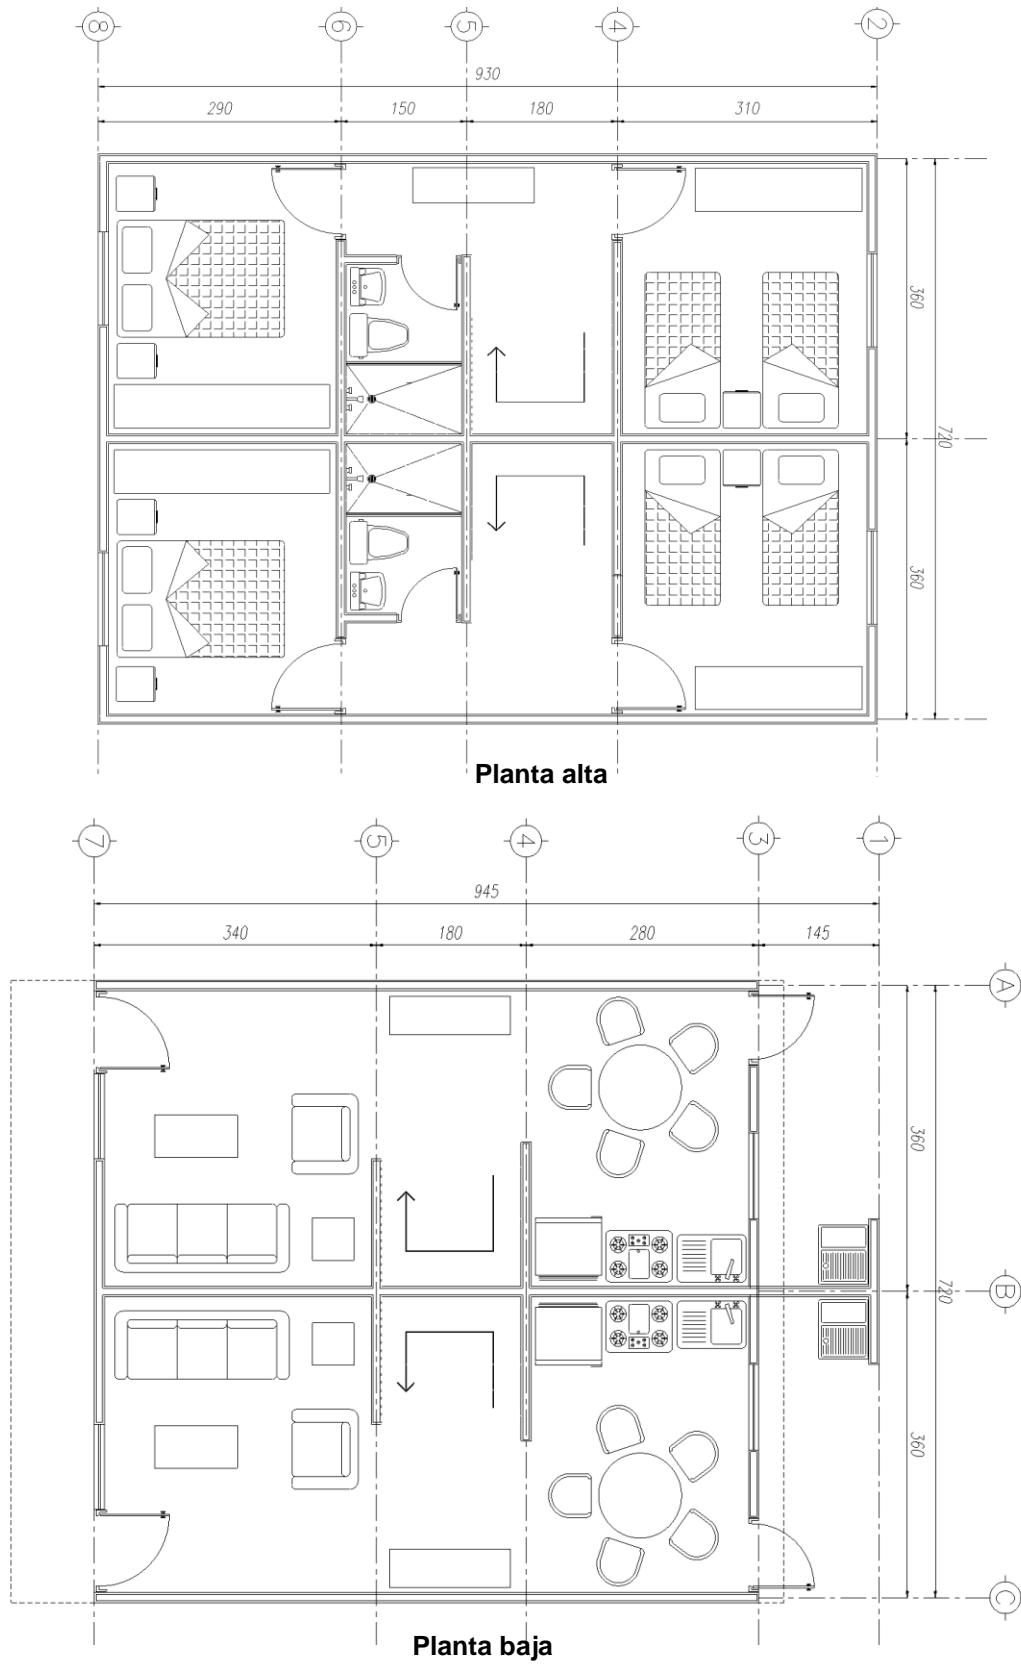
Planta arquitectónica del prototipo Rancho Victoria
